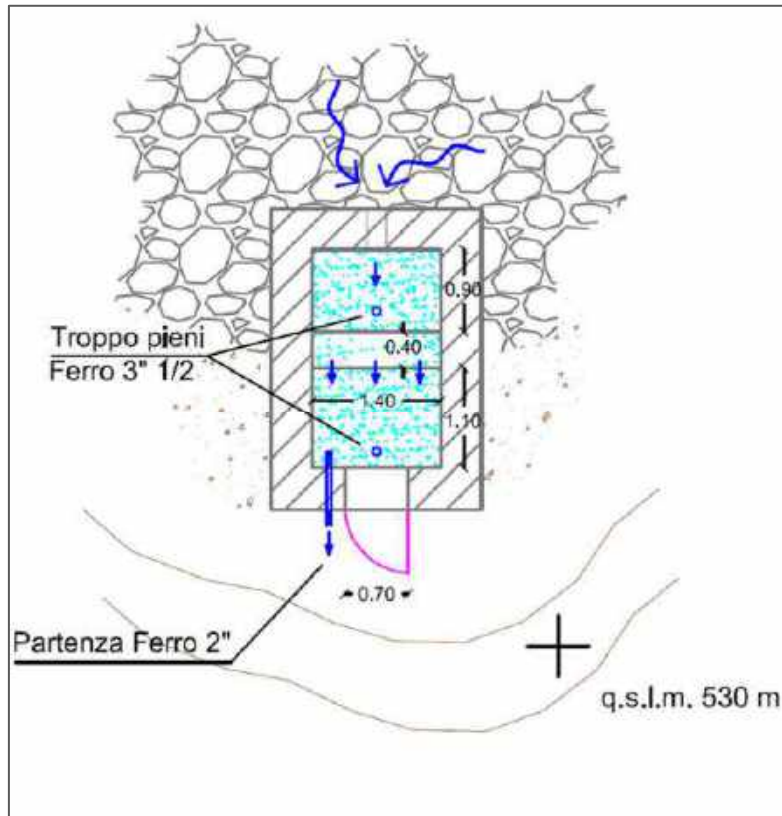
Pianta e Prospetto frontale Sorgente 2 Boscacci
